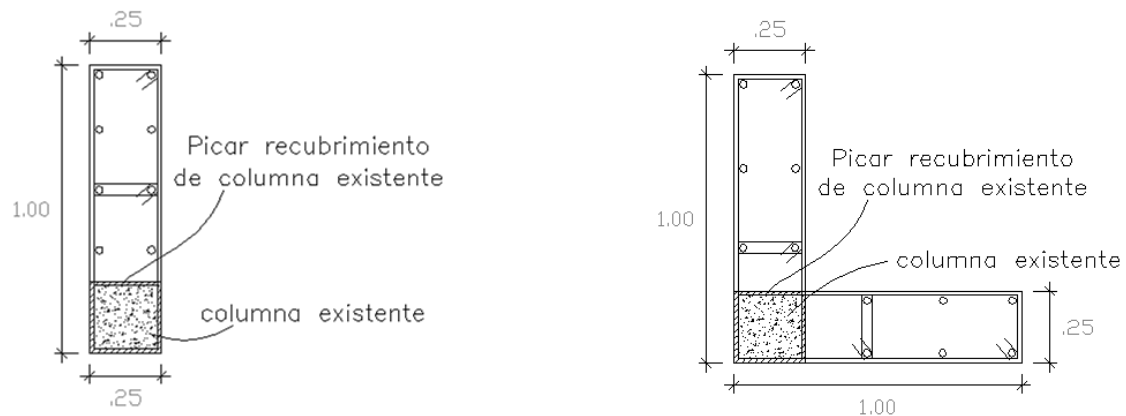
Detalle de reforzamiento para columna existente y esquinera.
